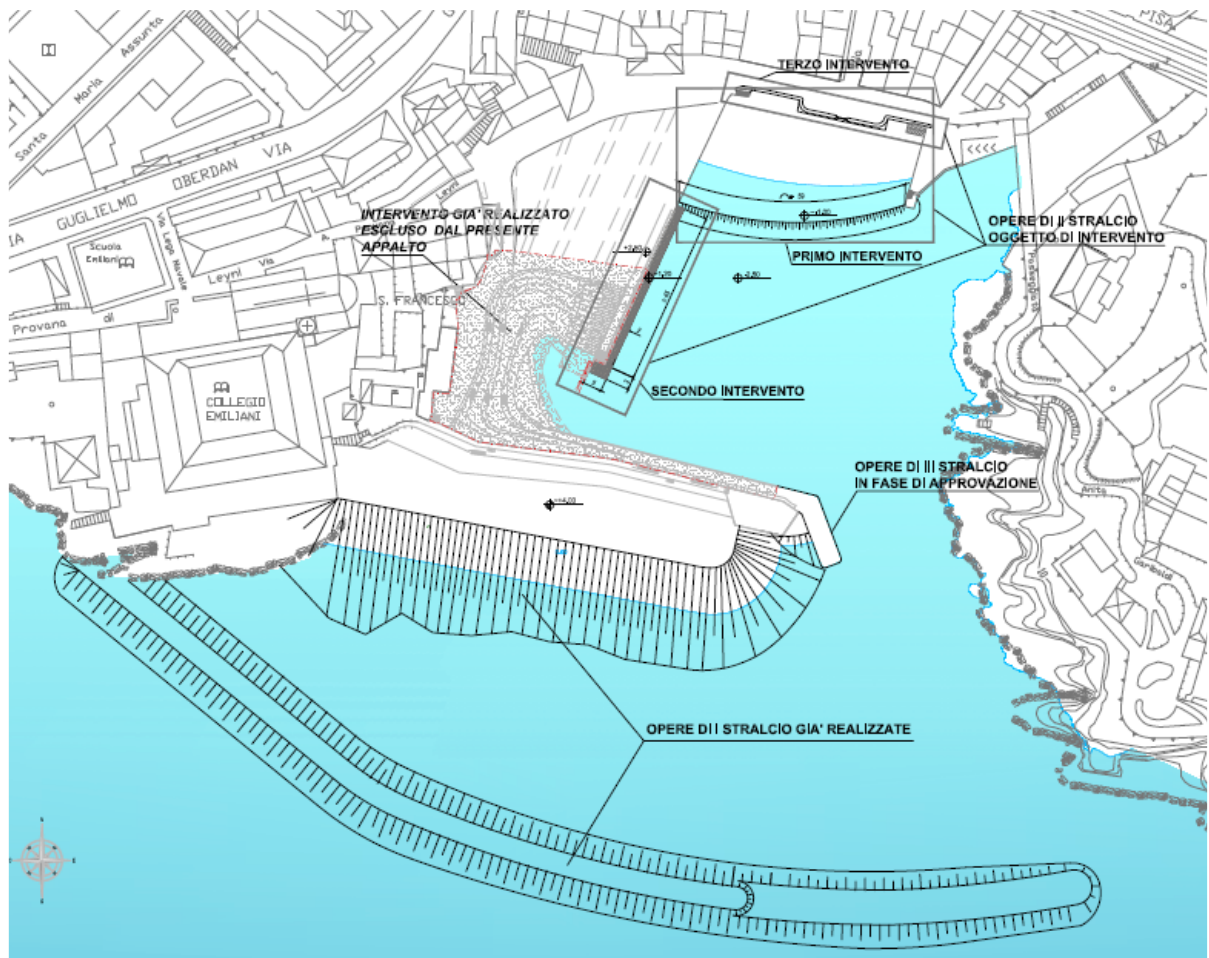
Interventi facenti parte dell'intervento complessivo e loro suddivisione
